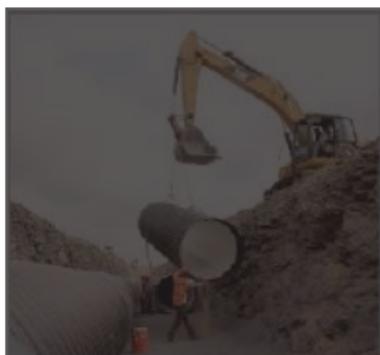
Bajado con maquinaria de tubería a la zanja, usar dos puntos de sujeción.
